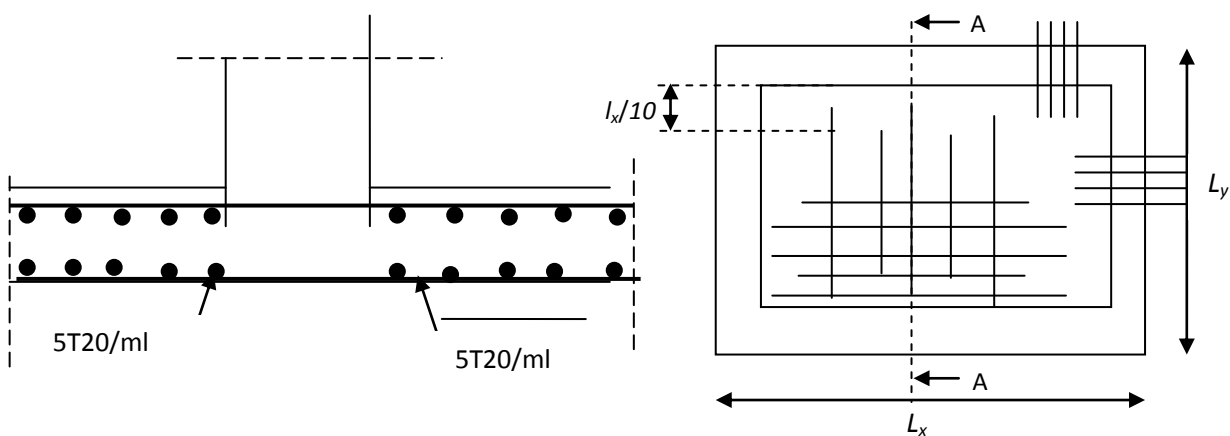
Schéma de ferrailage de la dalle du radier
